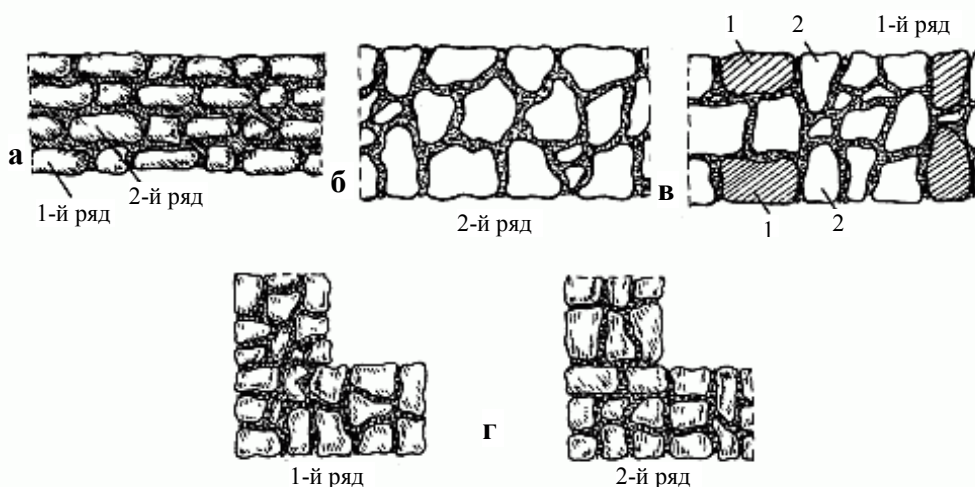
Перев’язування мурування з бутового каменю: а – фасад стіни; б – план другого ряду мурування; в – план першого ряду мурування; г – перев’язування кутів; 1 – камінь чолової верстви, покладений довжиком; 2 – те саме, покладене поперечником
